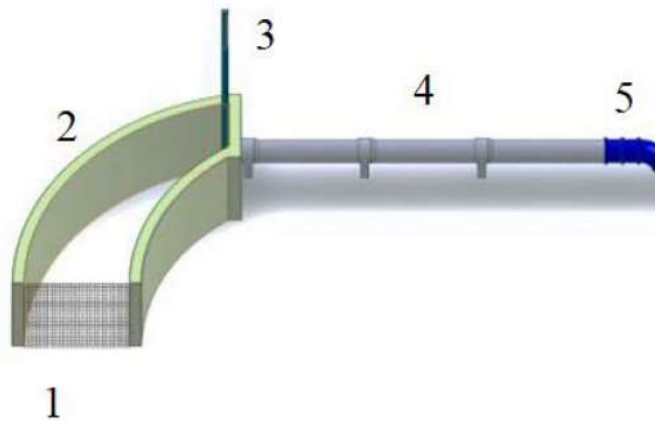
Водозабірний вузол з напірним трубопроводом: 1 – металева захисна решітка; 2 – стінки водозабірного вузла; 3 – затвор; 4 – дериваційний напірний трубопровід; 5 – турбінний трубопровід
